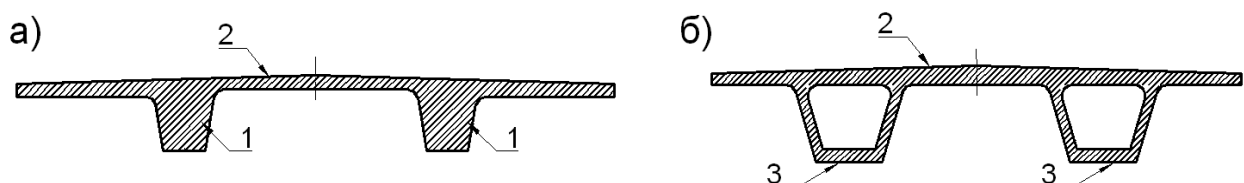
Двобалкові монолітні залізобетонні прогонові будови:
